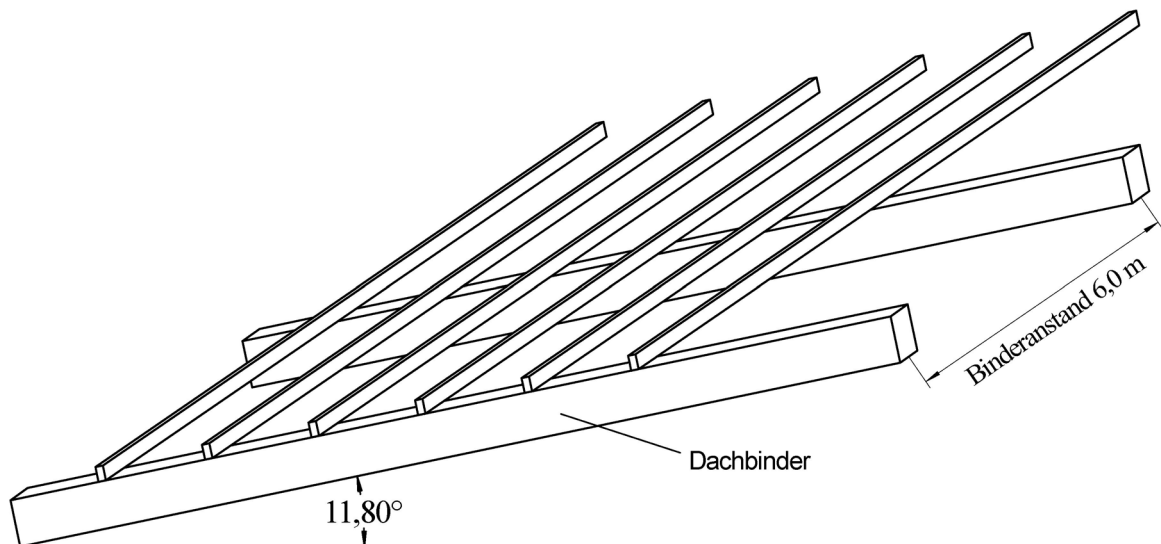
Lage der Sparrenpfetten auf den Dachbindern
